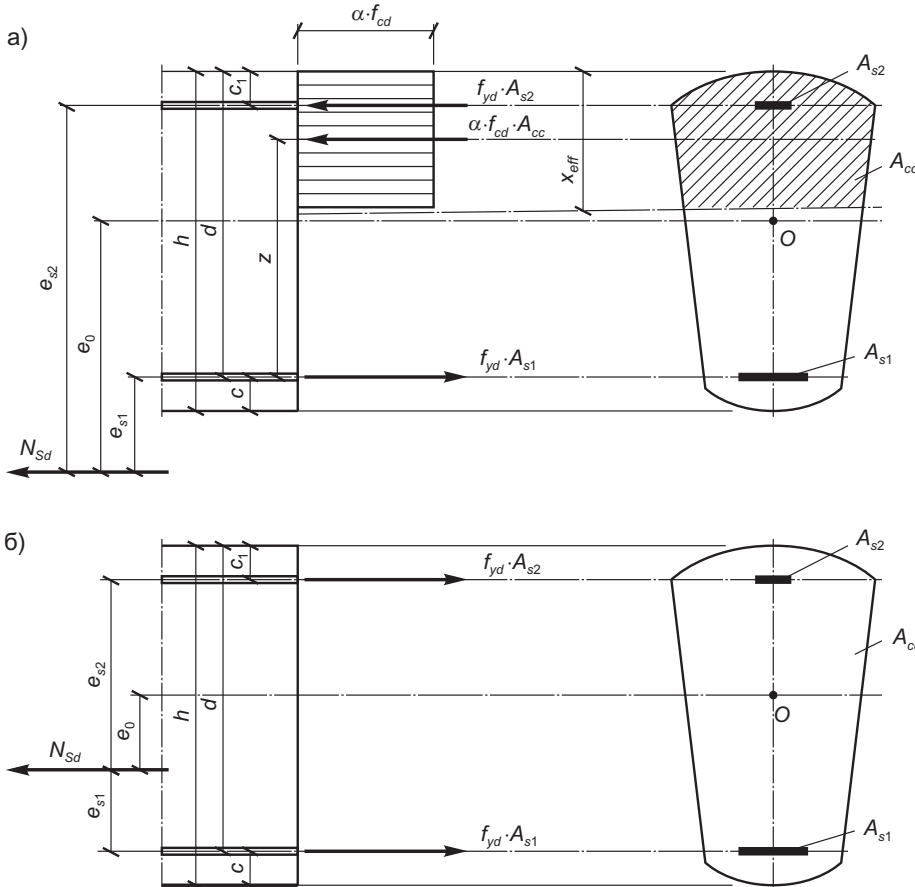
Схема усилий и эпюра напряжений в сечении, нормальном к продольной оси внецентренно растянутого железобетонного элемента, при расчете по прочности:
